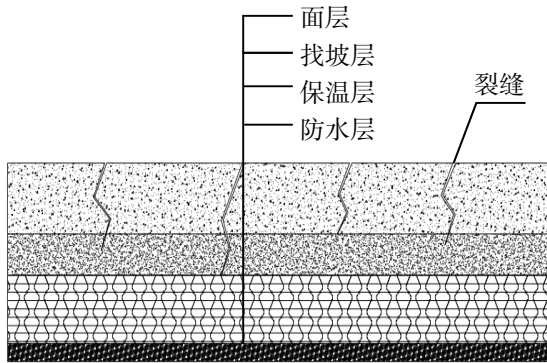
屋面防水保护层裂缝剖面图(屋面现状)
